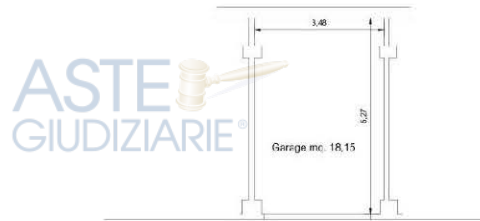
Elaborato planimetrico del piano interrato del fabbricato con indicazione della posizione del box oggetto di esecuzione
